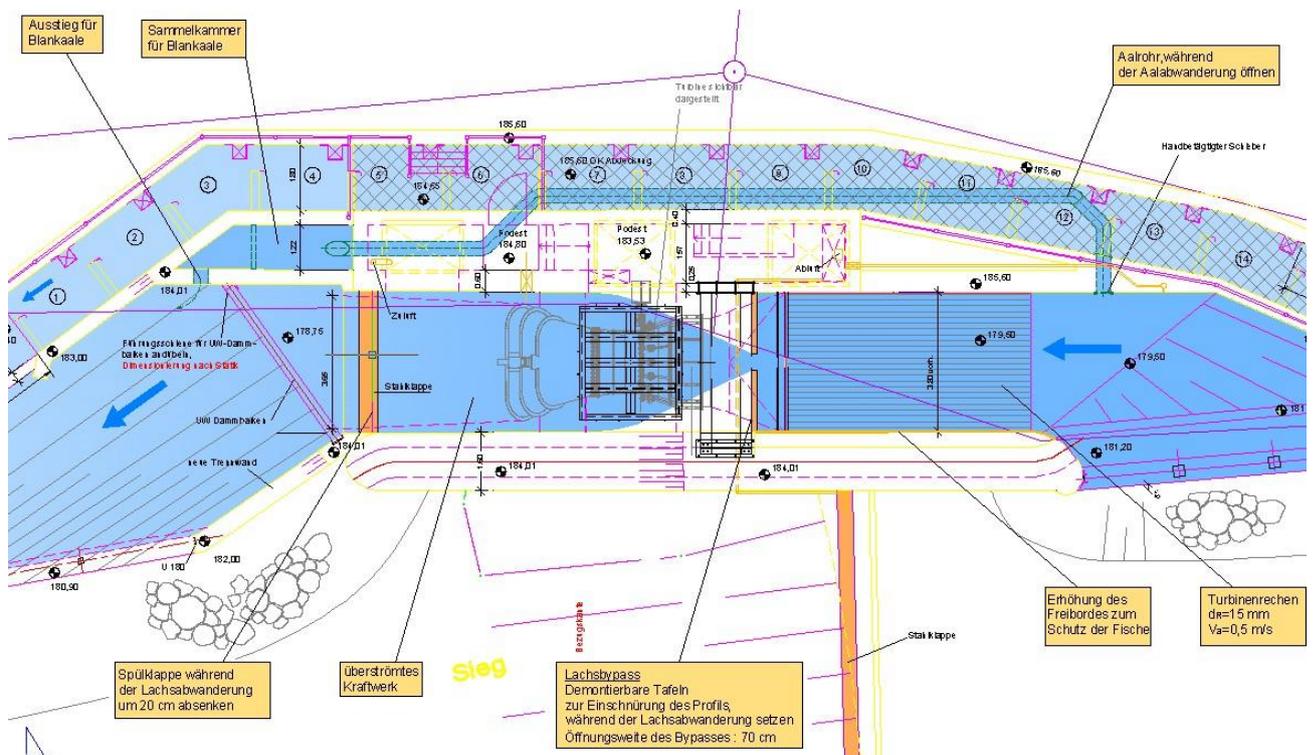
Lageplan WKA mit Rechen (15 mm) und Bypässen
